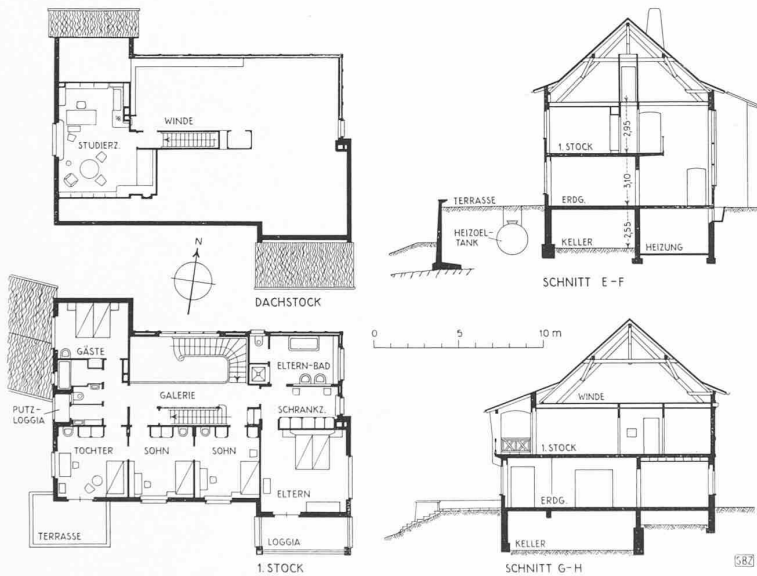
Grundrisse und Schnitte 1:400
